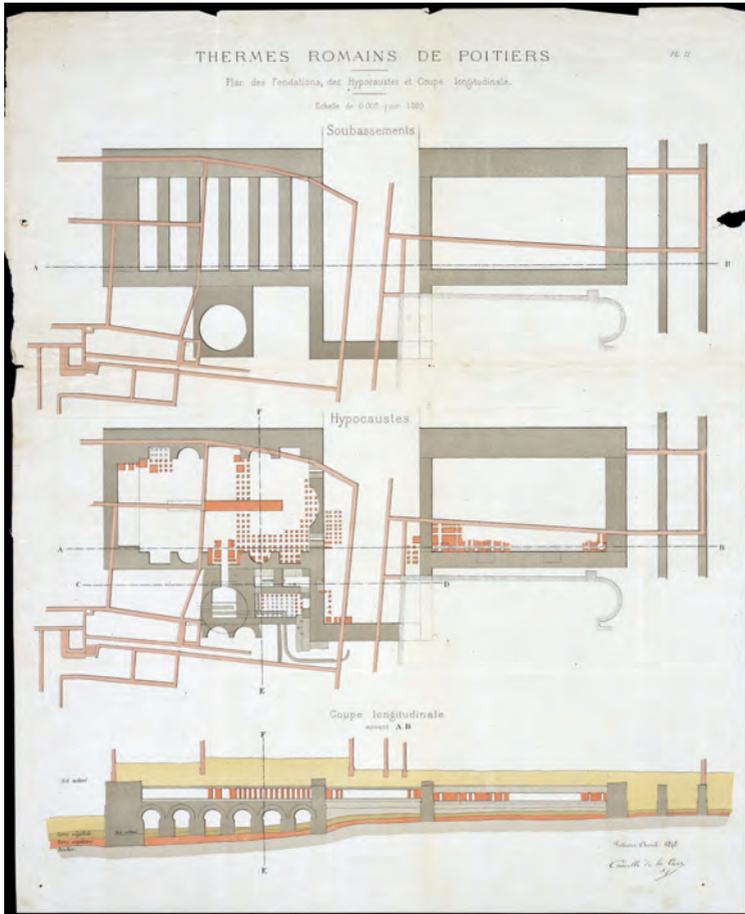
Thermes romains. Plan des fondations, des hypocaustes et coupe longitudinale, Poitiers (Vienne), Camille de la Croix, avril 1878.
